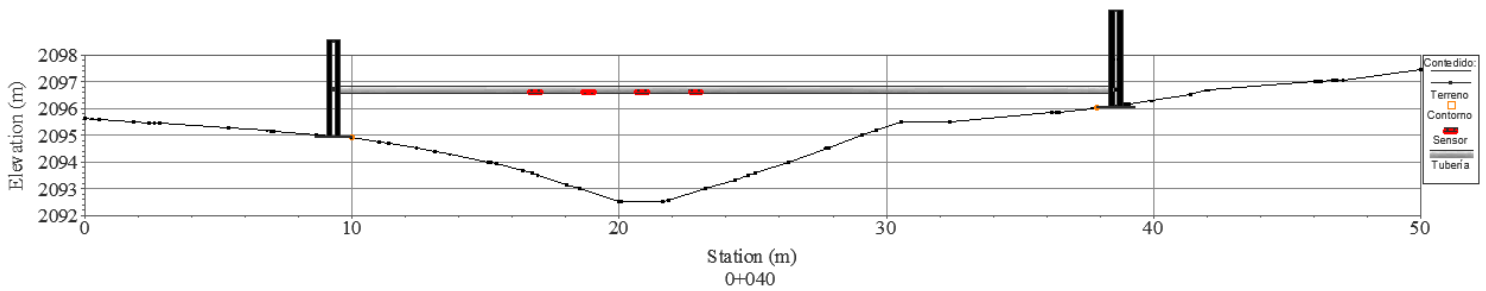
Esquema de la ubicación de los sensores HC-SR04 en la sección transversal 0+040 (aguas abajo).
